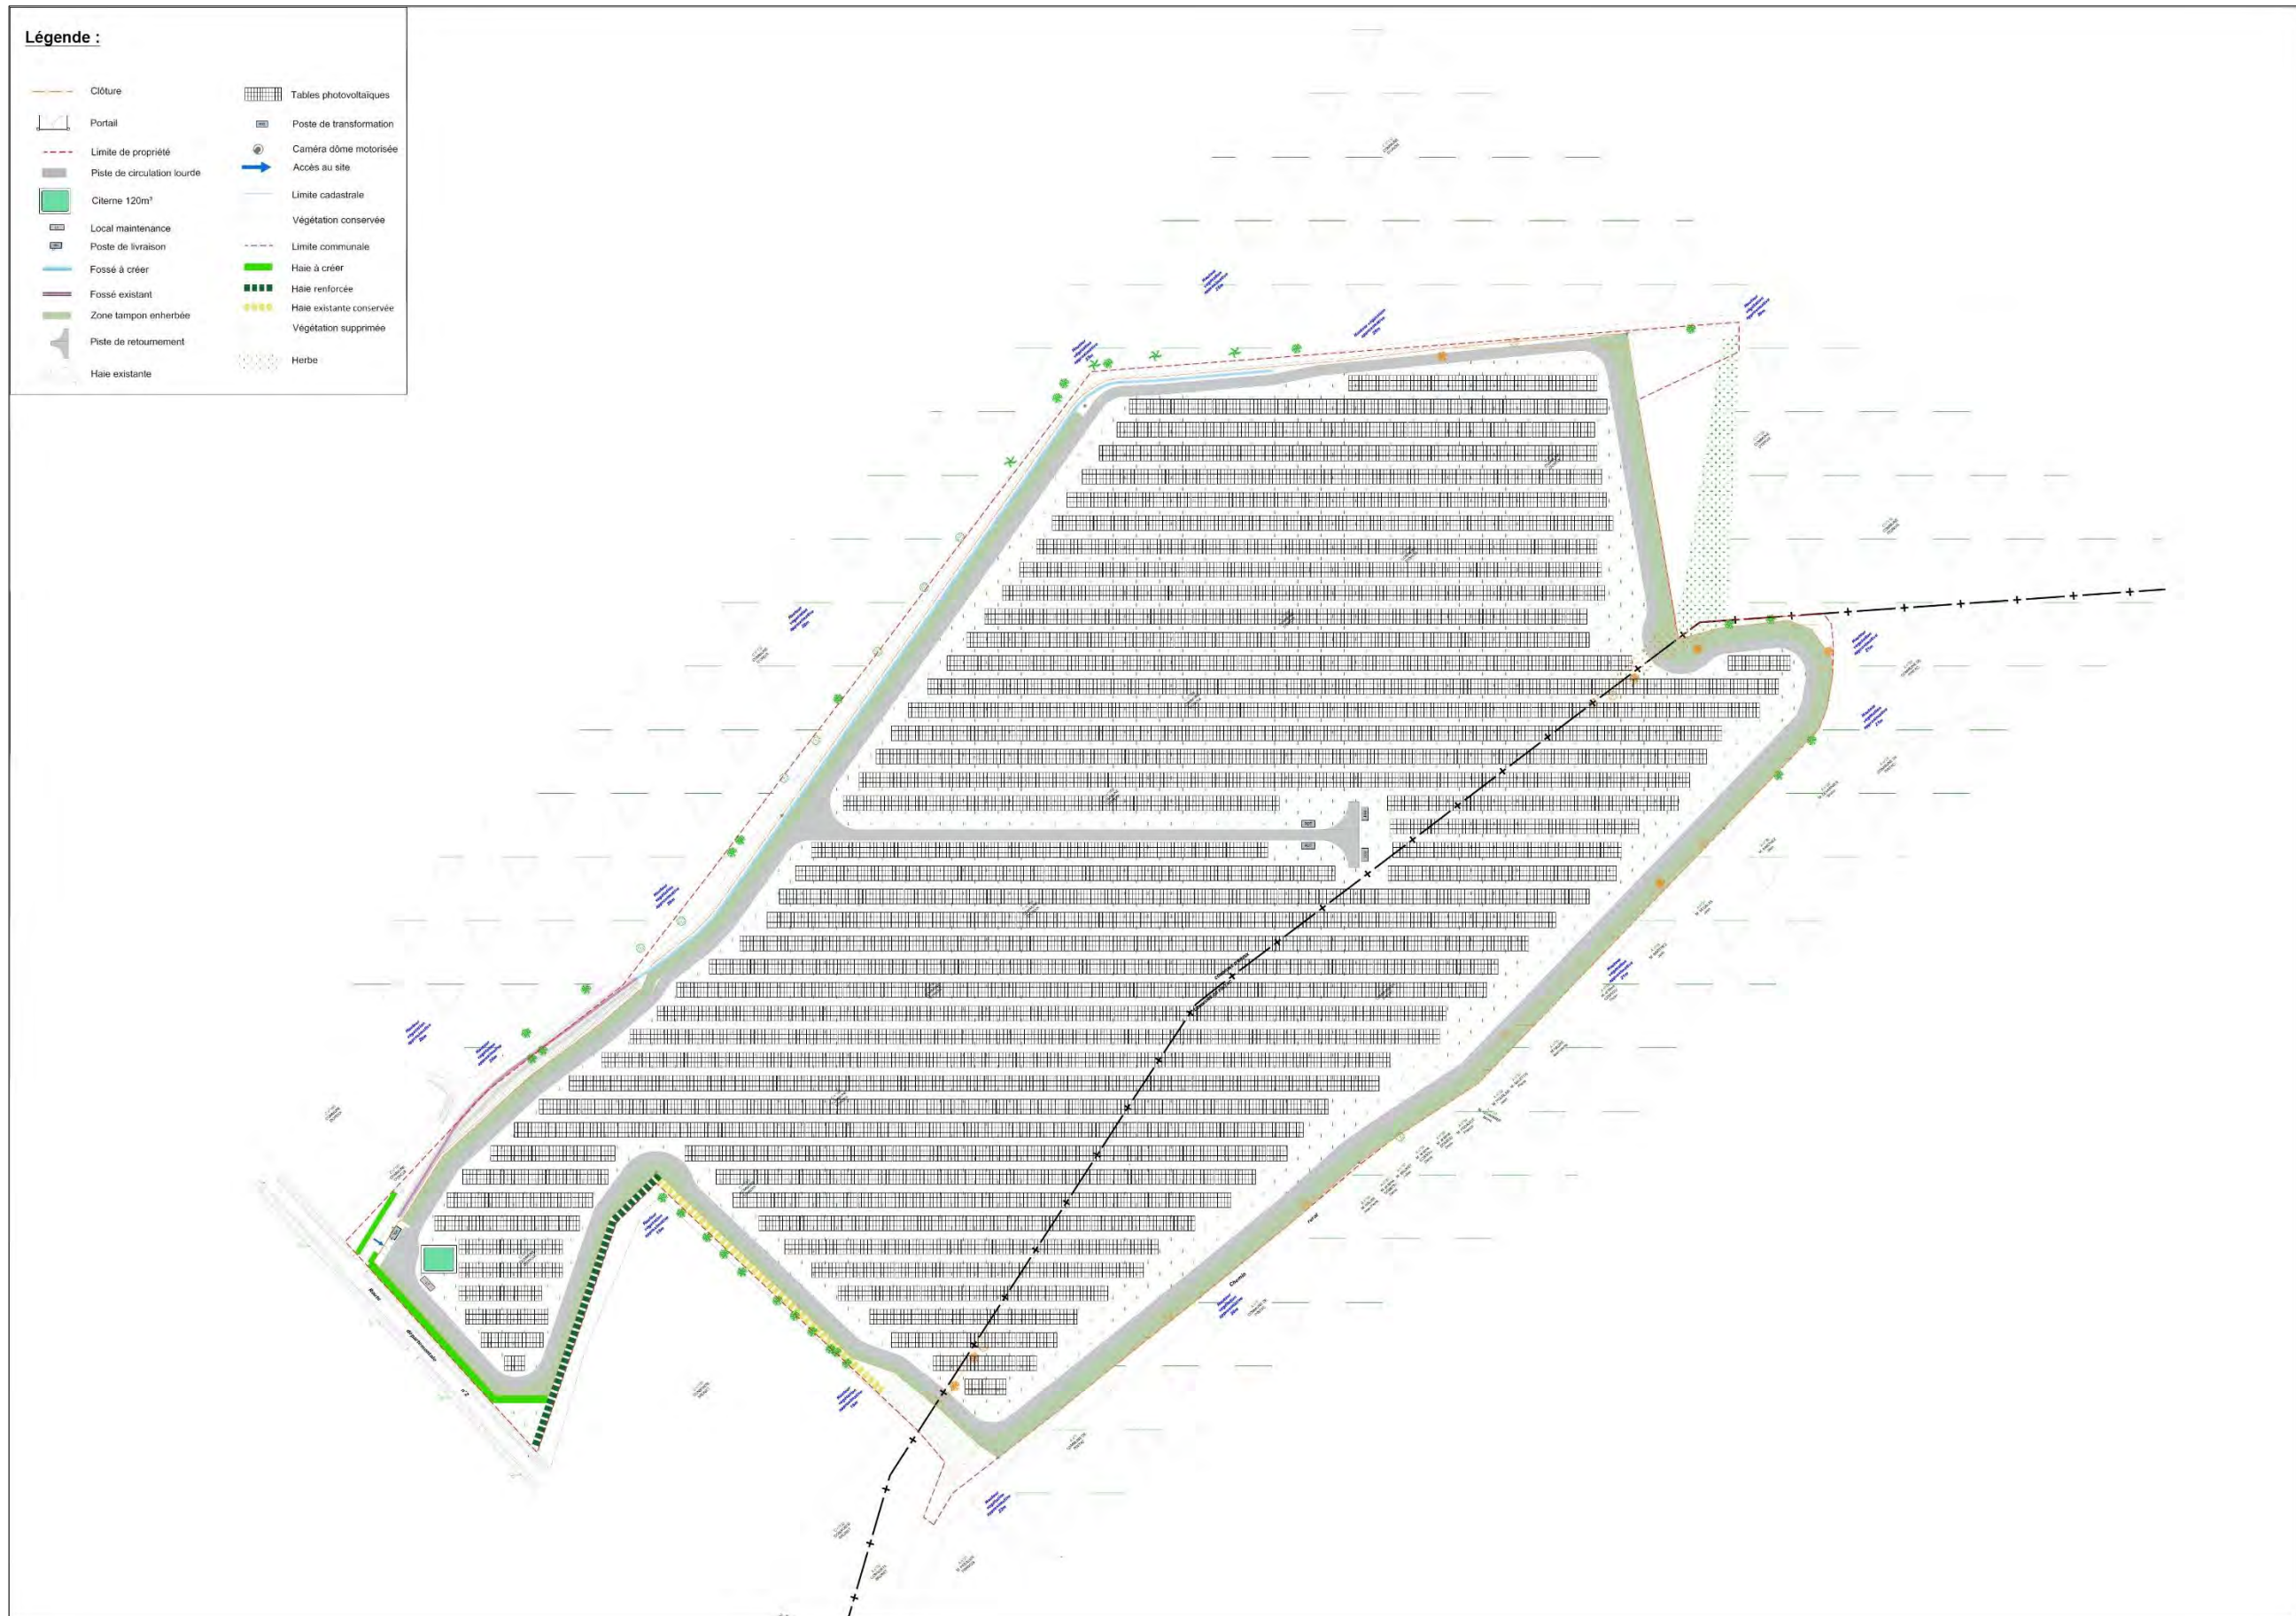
Plan de principe du projet (Source : URBASOLAR)
